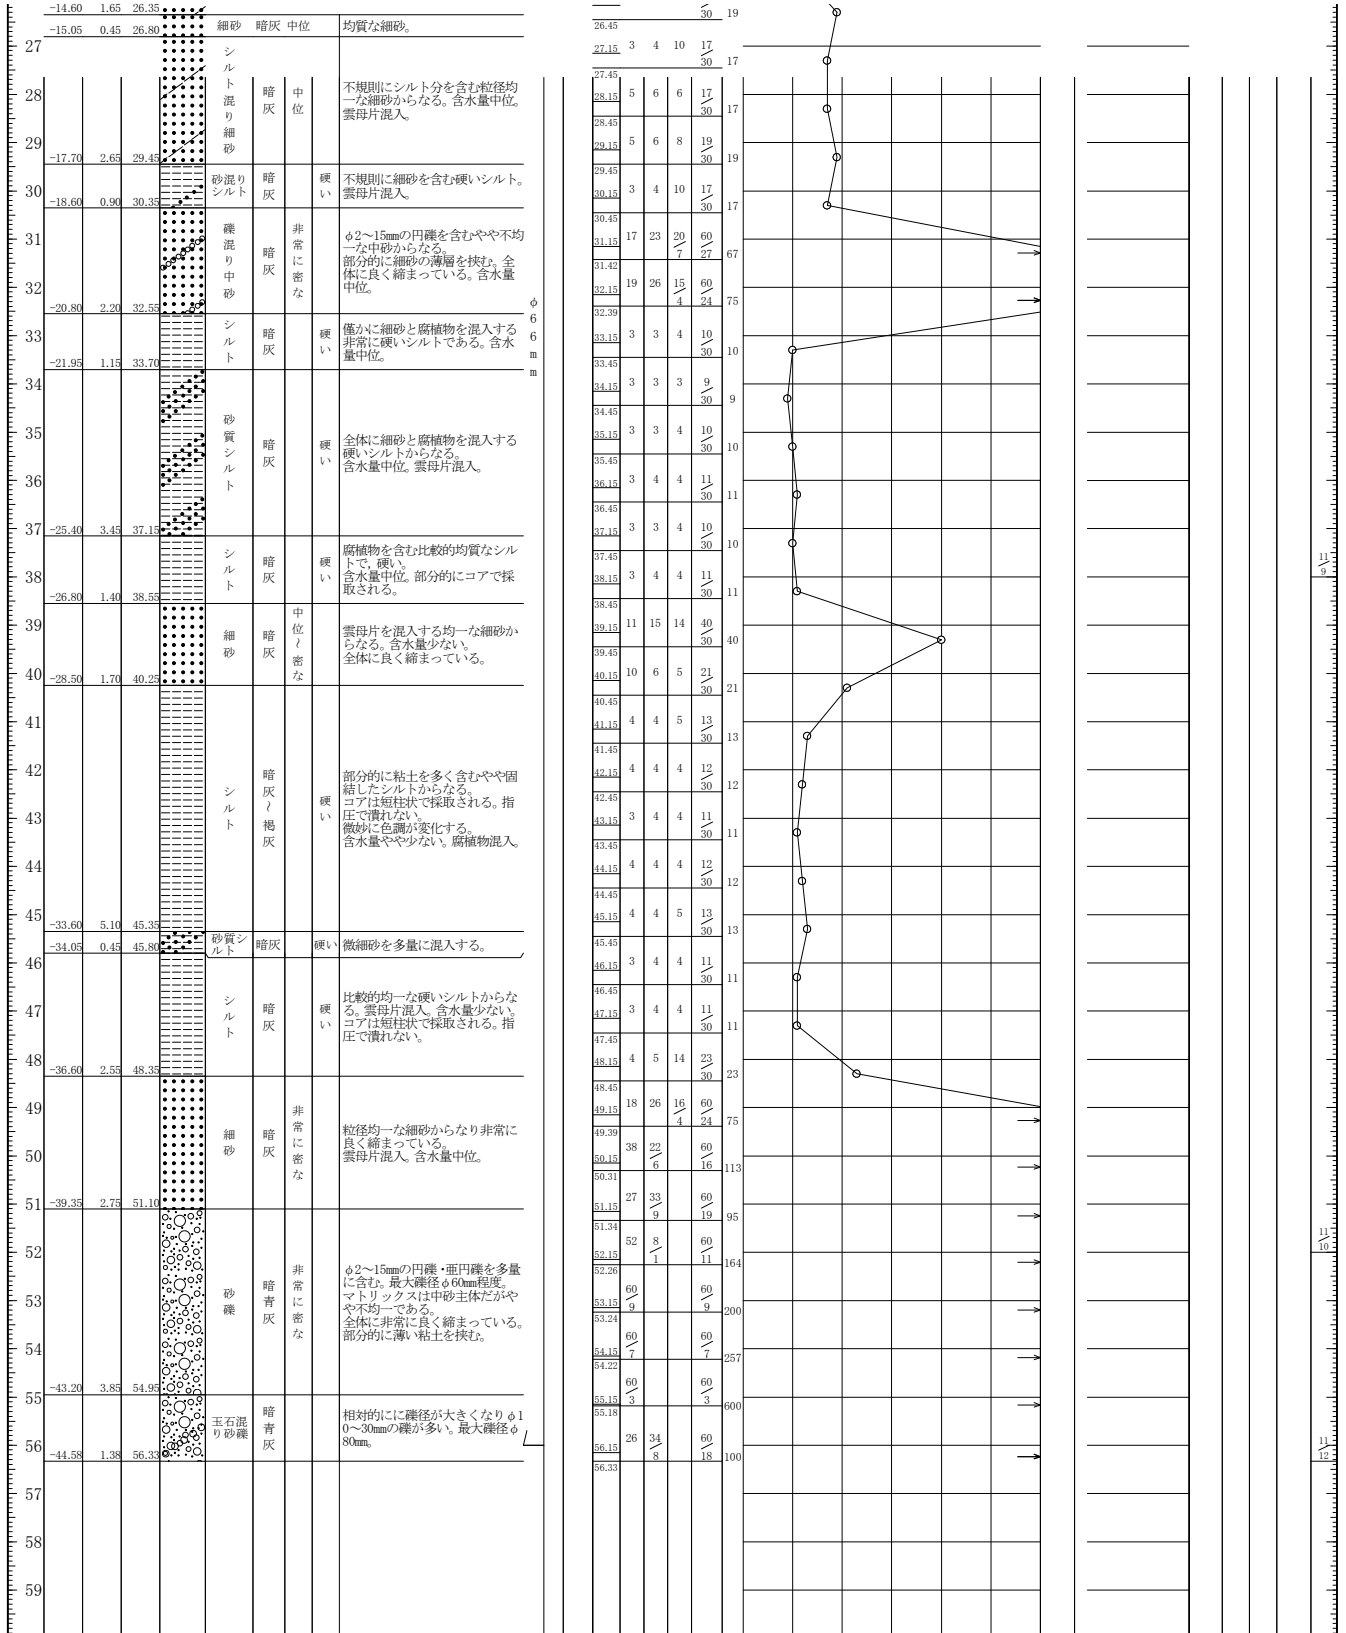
(1) ボーリング柱状図 (No.5-1)
